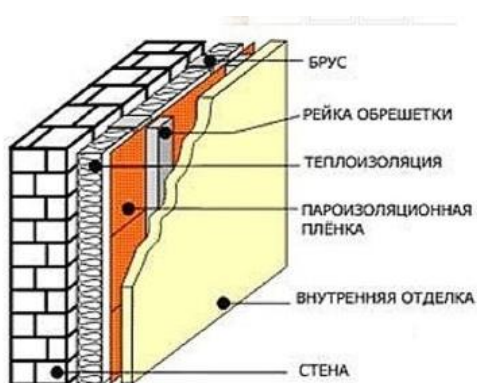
Конструкция наружной стены с внутренней теплоизоляцией.
